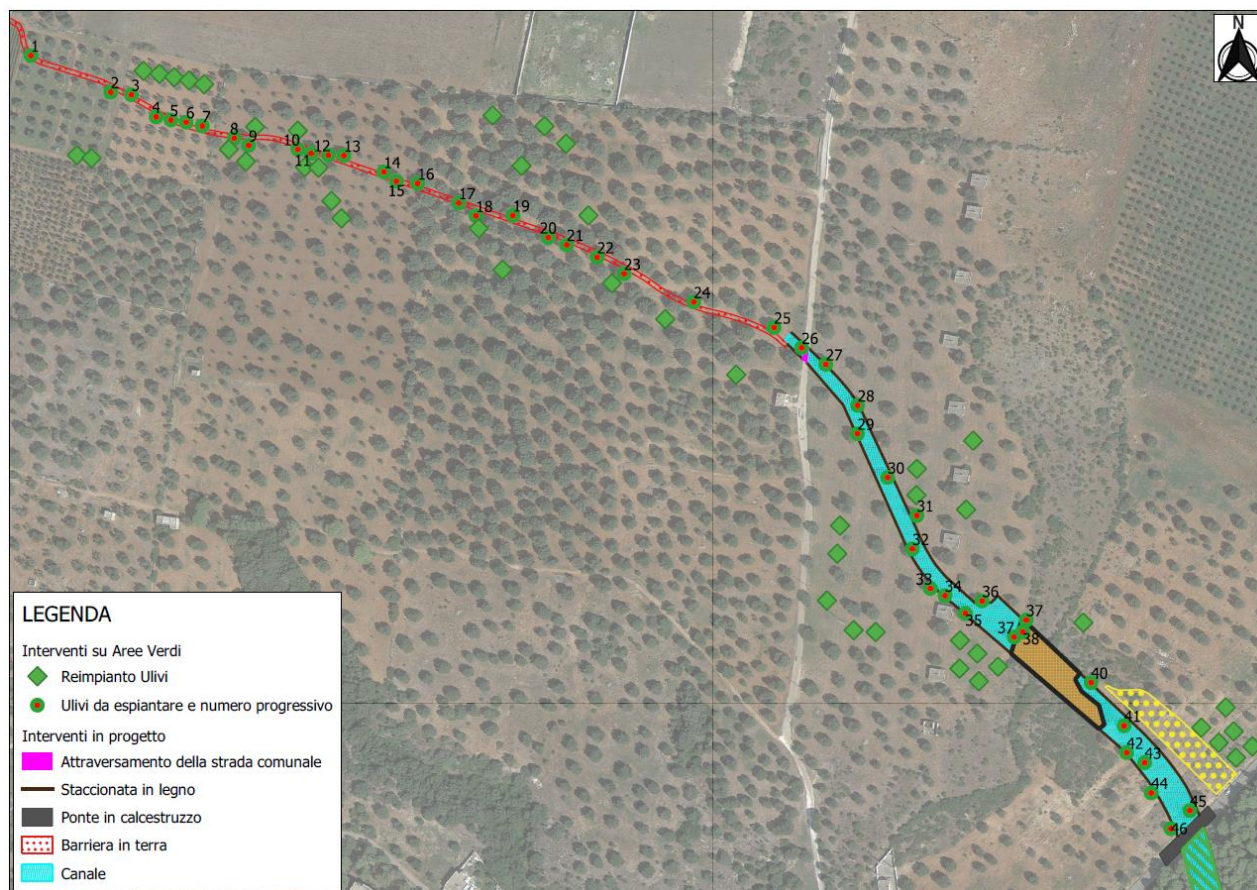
Planimetria con indicazione degli ulivi da rimuovere e ubicazione del reimpianto
